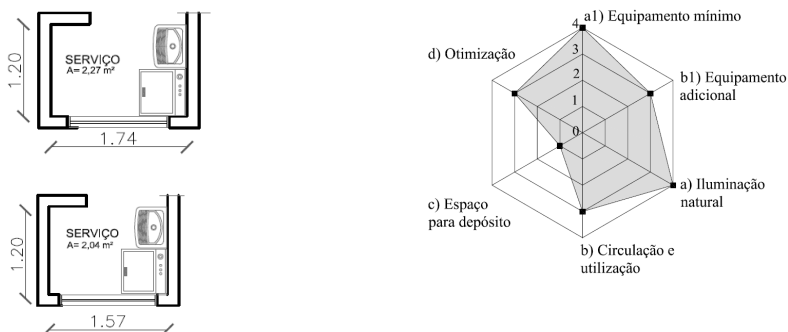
a) Planta baixa área de serviço tipo a com 1,74m de largura. b) Planta baixa área de serviço Tipo A com 1,57m. c) Modelo radar da área de serviço Tipo A e B.
